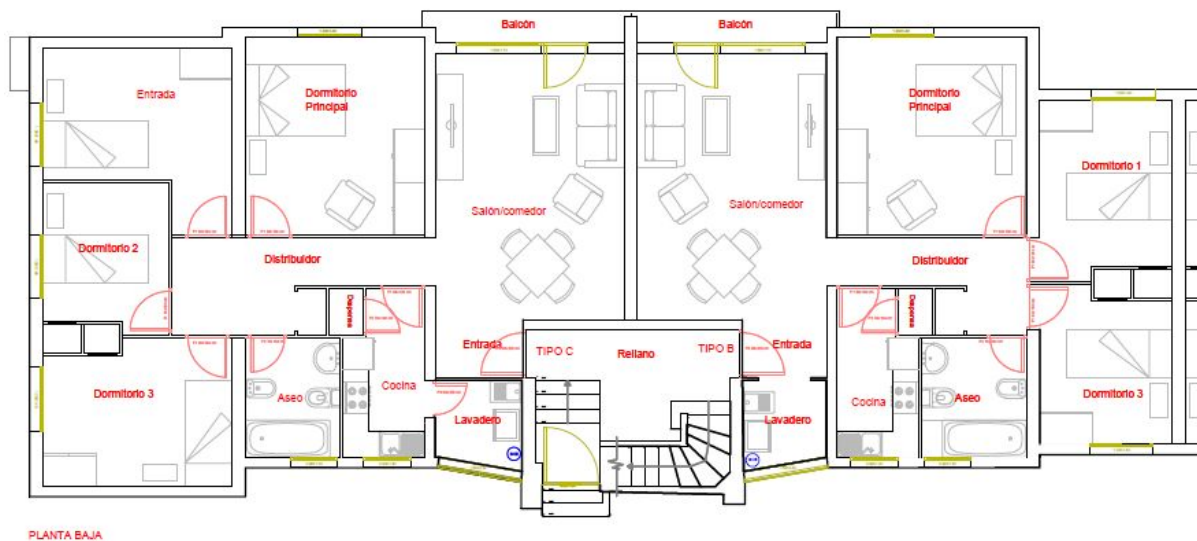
Planta del bloque H, escalera 5, PB (Fuente: Anejo A)
